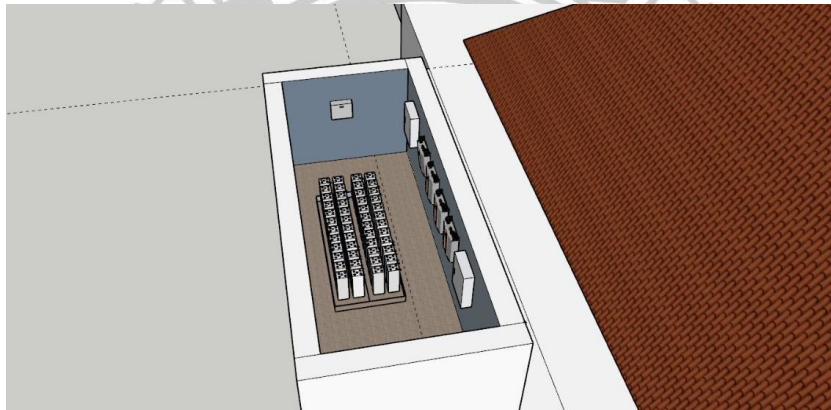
Desain Layout PLTS Sisi Rooftop Tampak Samping
